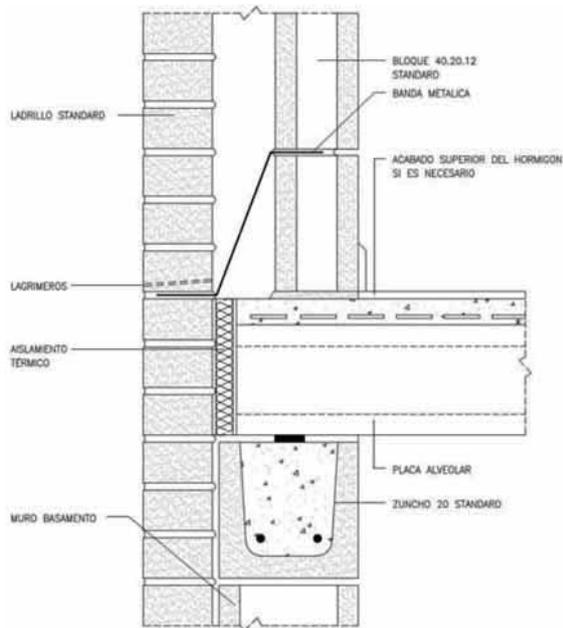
Sección de encuentro de muro de 2 hojas de ladrillo y bloque hueco de carga. Hoja exterior pasante apoyada en cimentación y hoja interior con apoyo de forjado sobre piezas zuncho.
